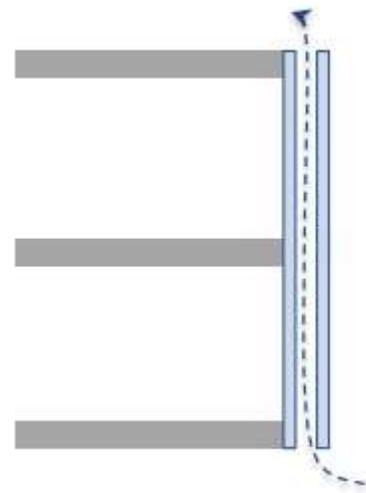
FACHADA VENTILADA. FUENTE: GLASSTECH.
